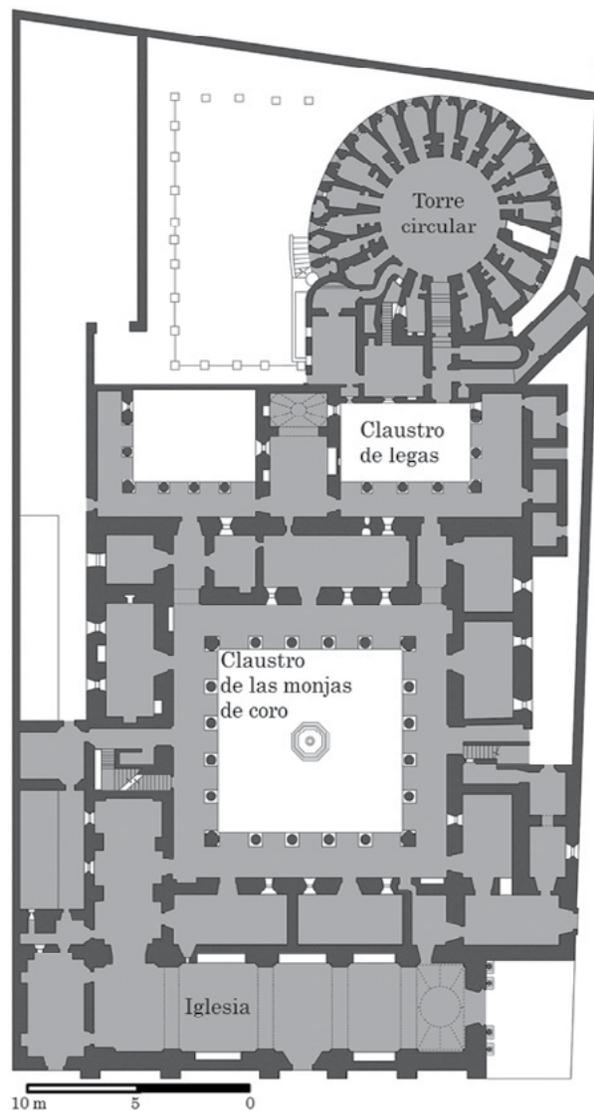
Plano de la planta inferior del convento de Capuchinas. Elaboración de la Escuela de Arquitectura-UFM.
